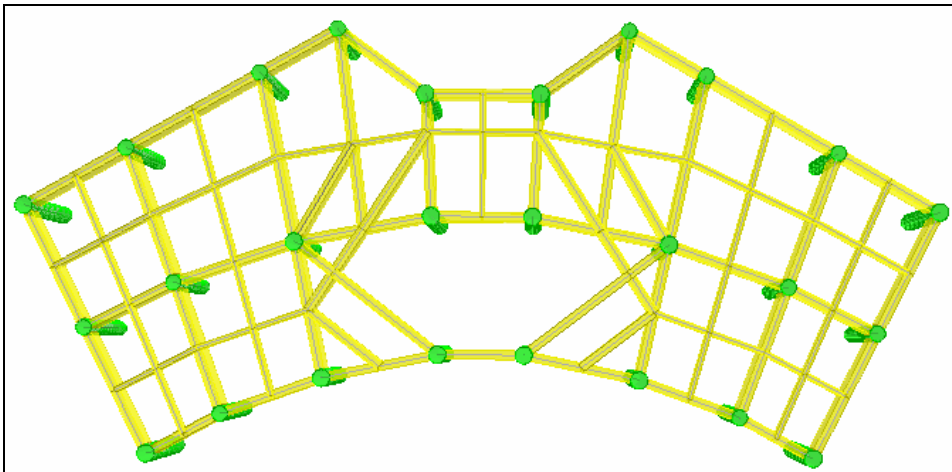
Nueva distribución de vigas y columnas para la platea baja.
